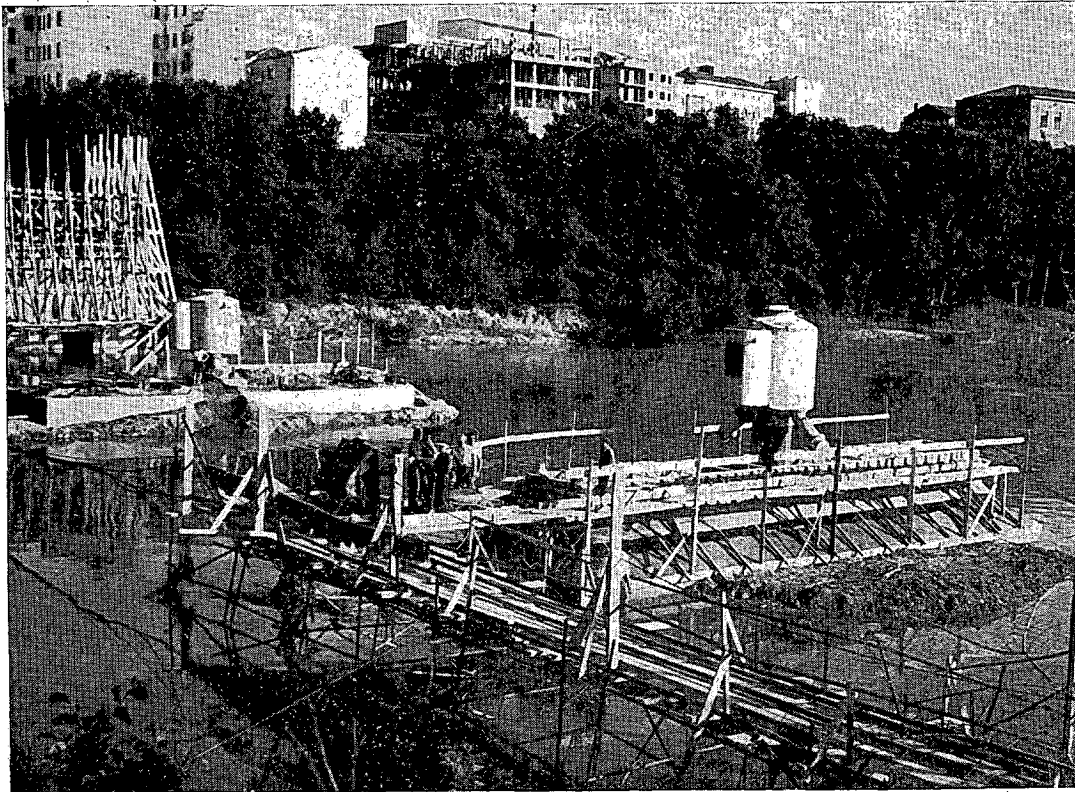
Cimentación de un puente por el sistema de cajones hincados con aire comprimido, construido sobre el río Pisuerga, en Valladolid.
